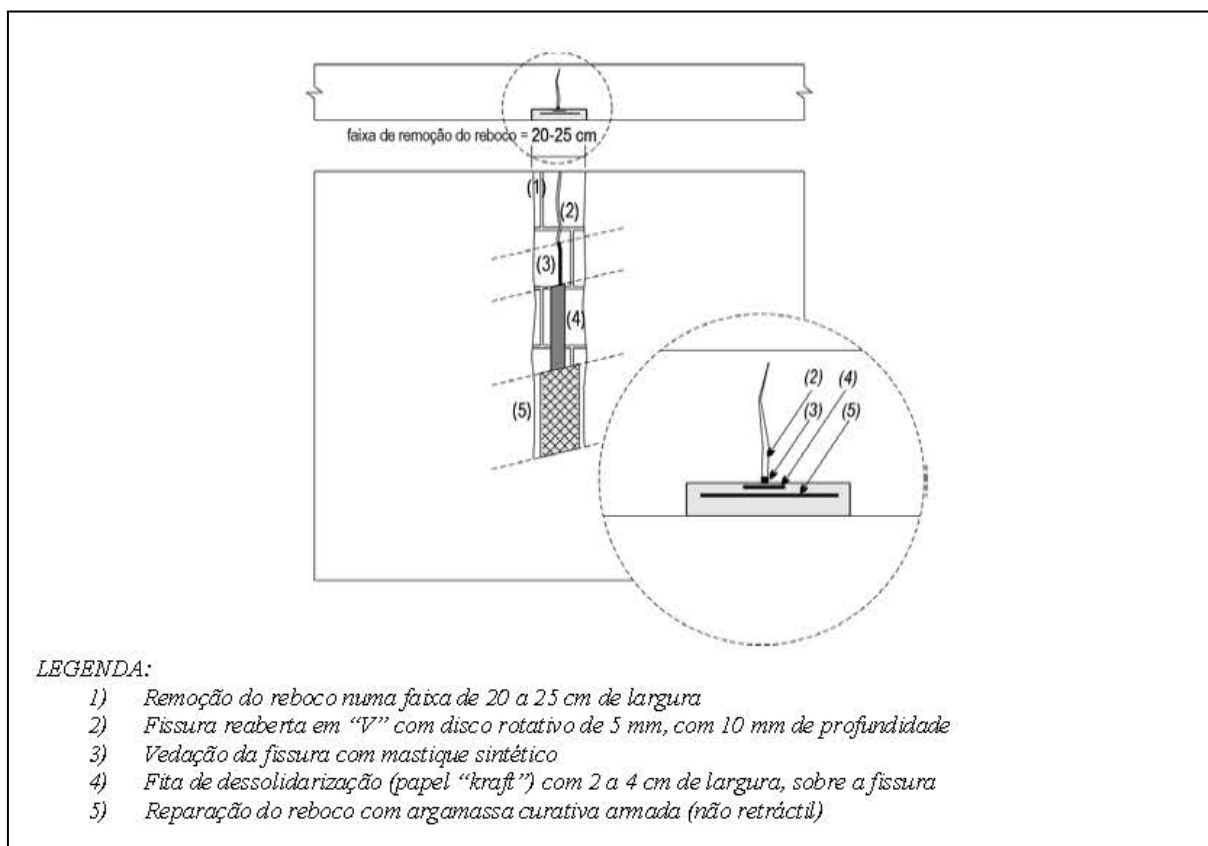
Esquema da reparação de fissuras em ponte (SILVA, 2002)
